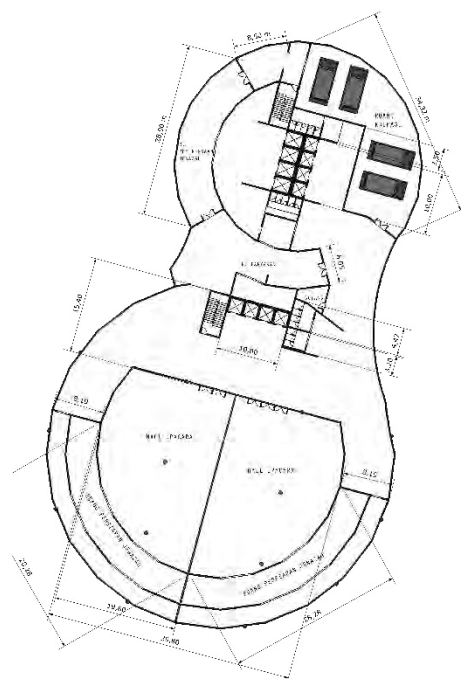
Siteplan Pemakaman Vertikal Tionghoa
